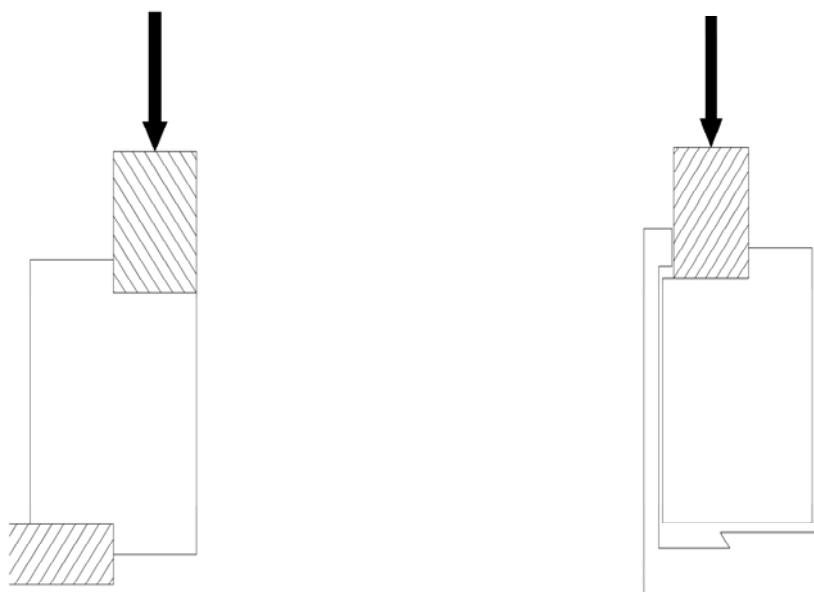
corpo de prova para ensaio de cisalhamento em um plano
